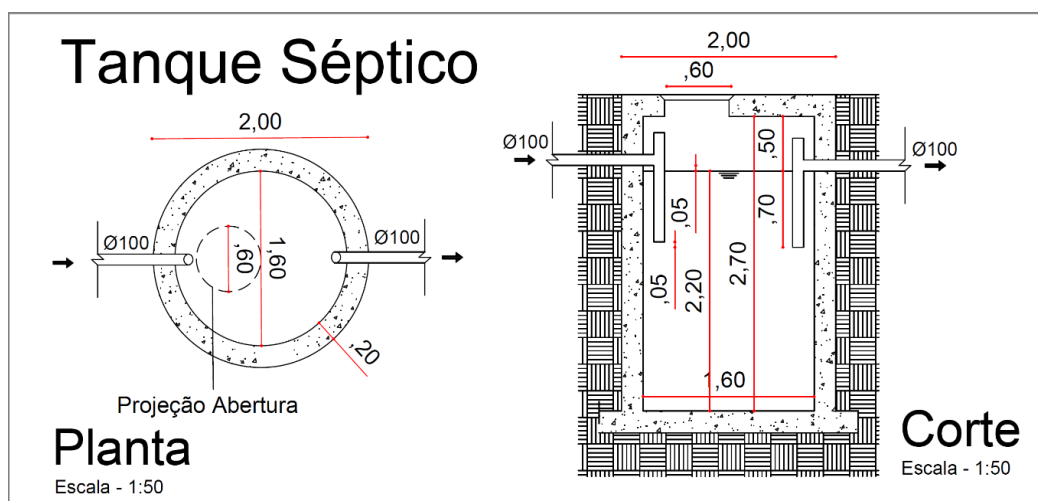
Planta e corte esquemático do tanque séptico. Fonte: O autor (2023)
